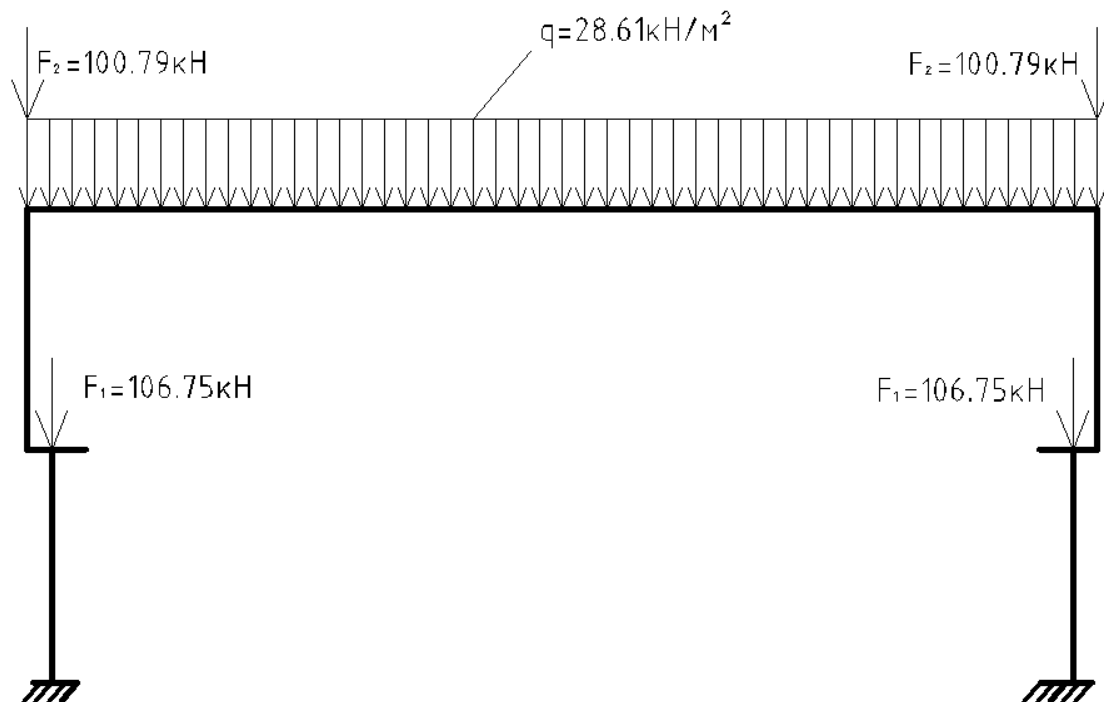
Расчетная схема при постоянной нагрузке от веса покрытия и фермы
